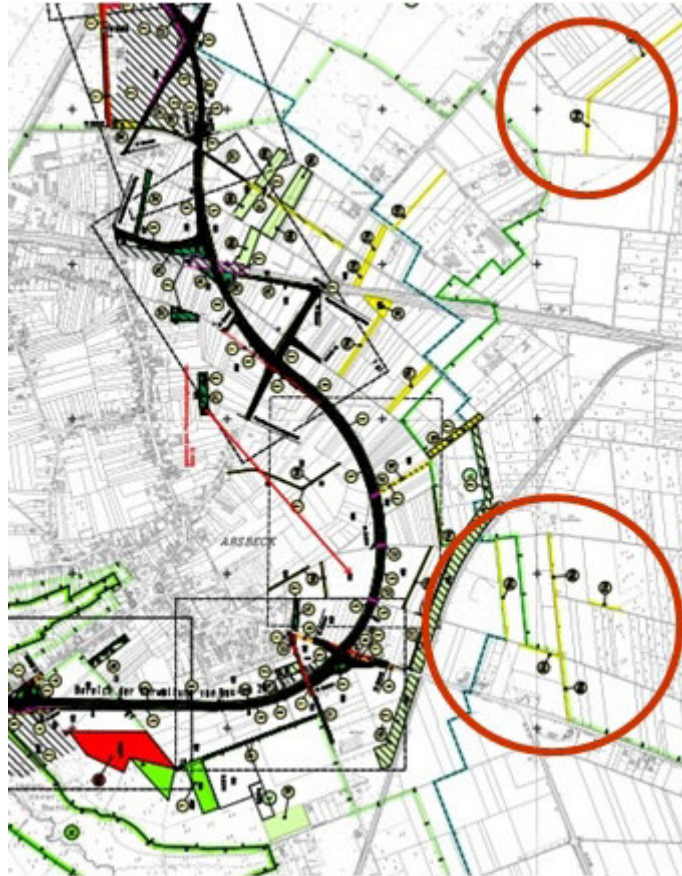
Ausschnitt aus dem Plan zur Planfeststellung der Bundesstraße B 221n mit gekennzeichneten kleinflächigen Kompensationsmaßnahmen; eigene Darstellung auf Grundlage des Planes zur Planfeststellung
